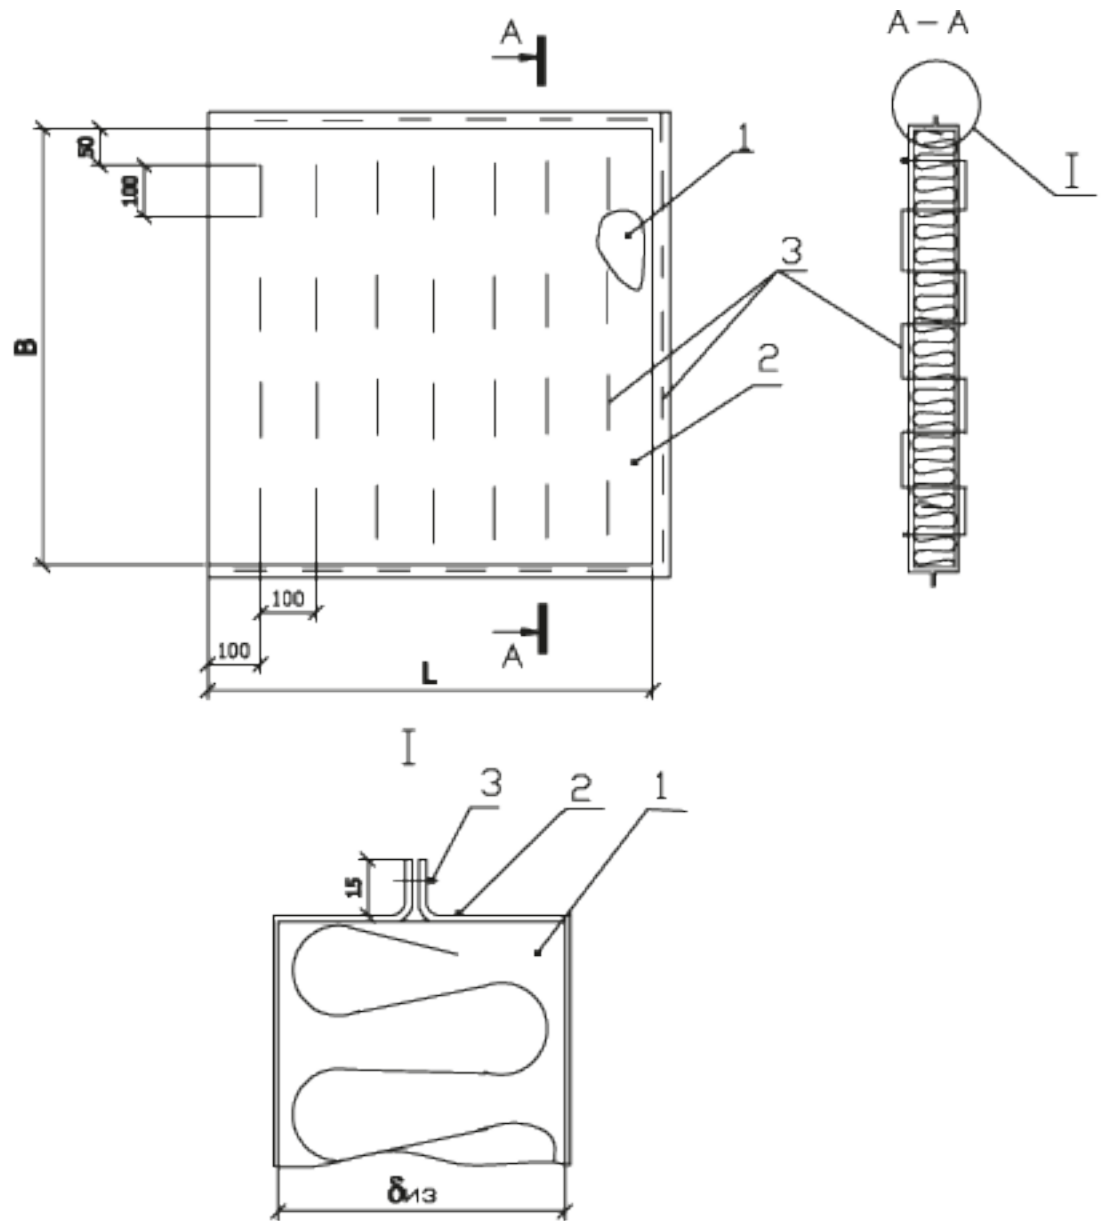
Изоляция фланцевой арматуры и фланцевых соединений трубопроводов с отрицательными температурами комплектными конструкциями с теплоизоляционным слоем из матов минераловатных
